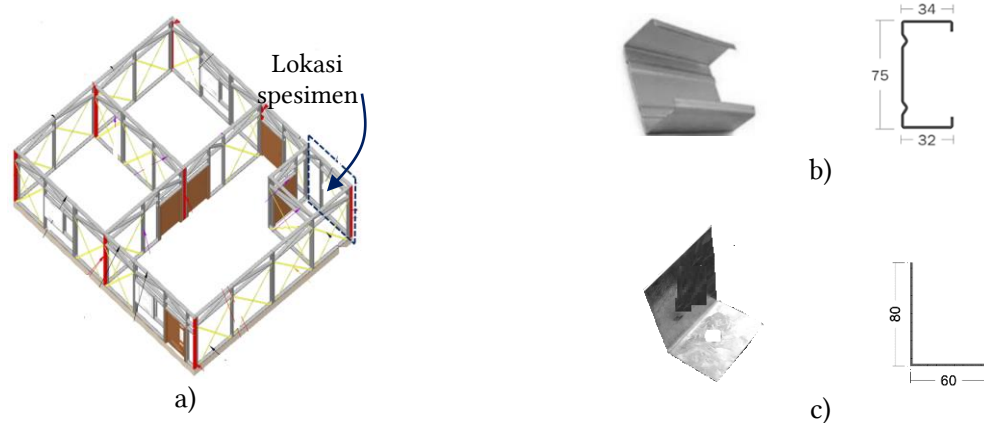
Bangunan RISBARI: a) Struktur bangunan, b) Penerapan dilapangan
